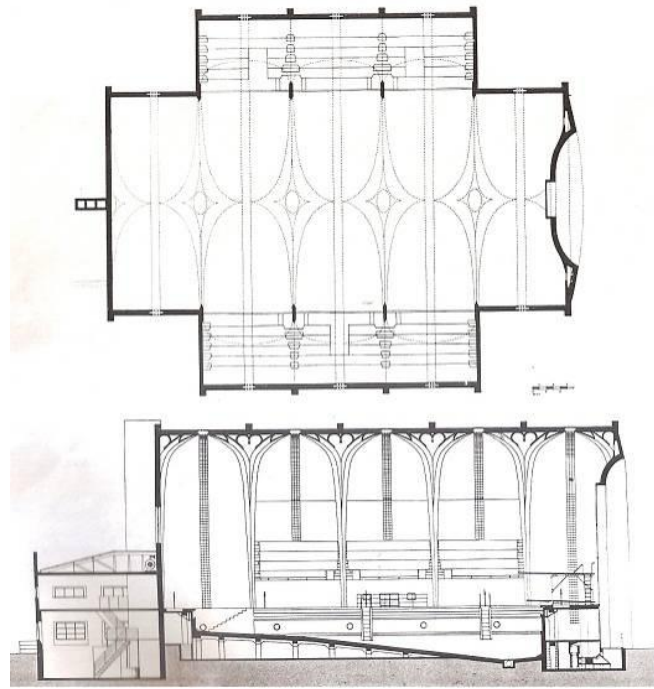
Grundriss und Schnitt der Sporthalle, 1937.
